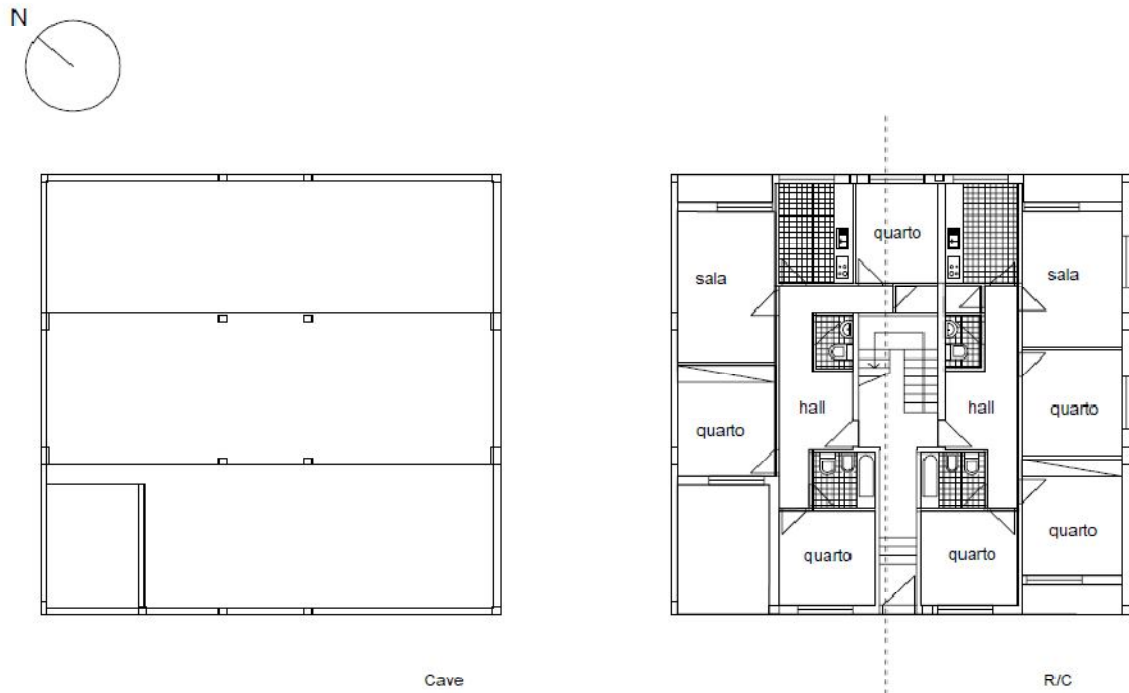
Plantas da cave e do r/c do edifício localizado em S. Victor
